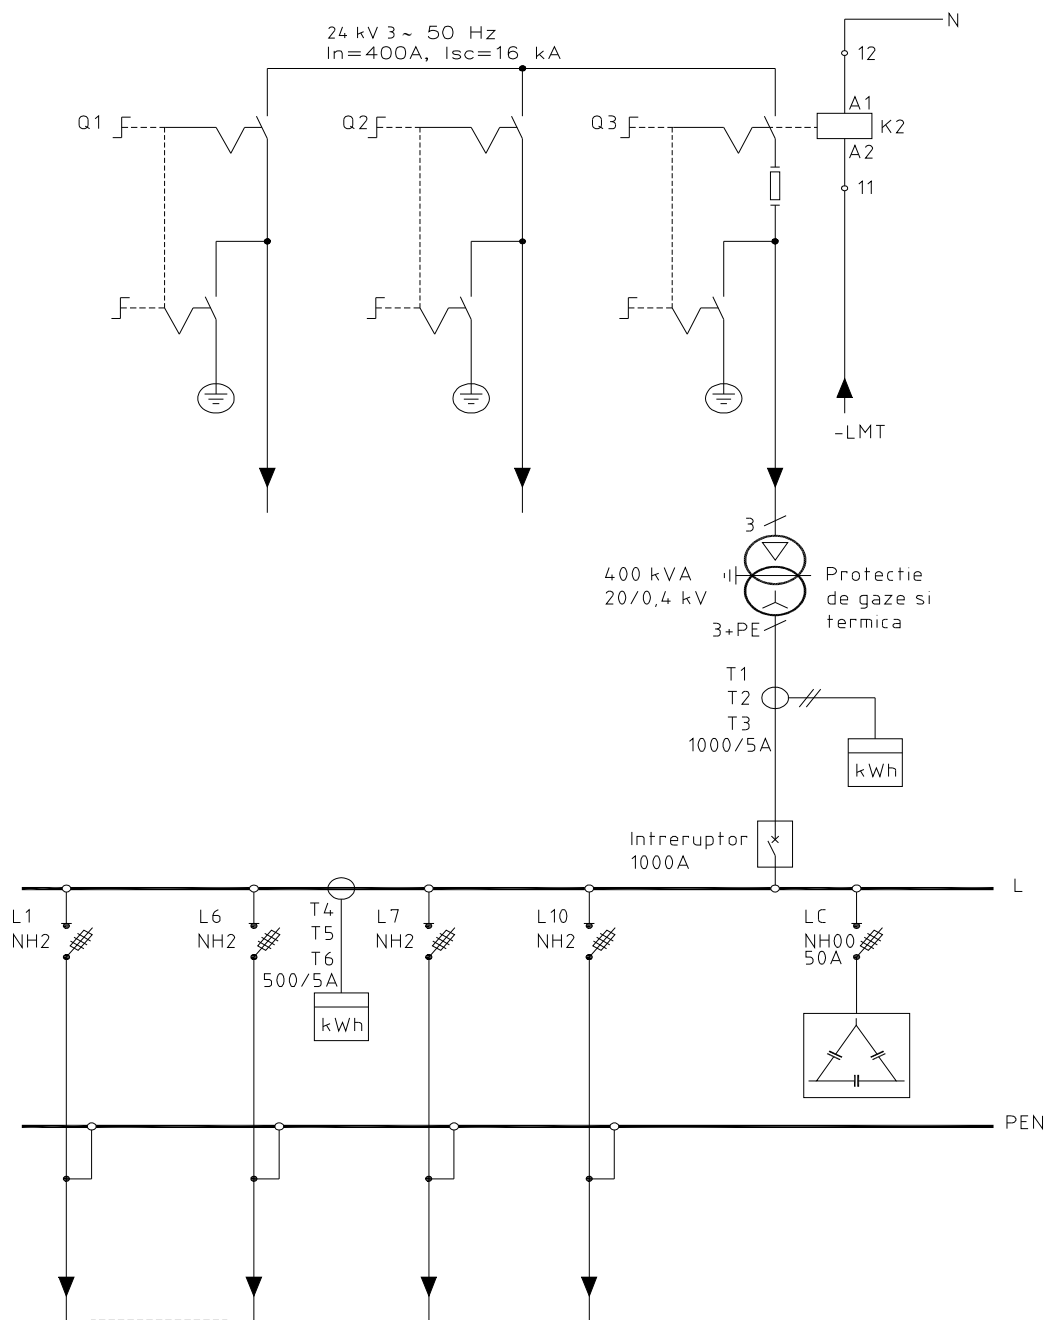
Schema electrică post în anvelopă de beton , montaj subteran
